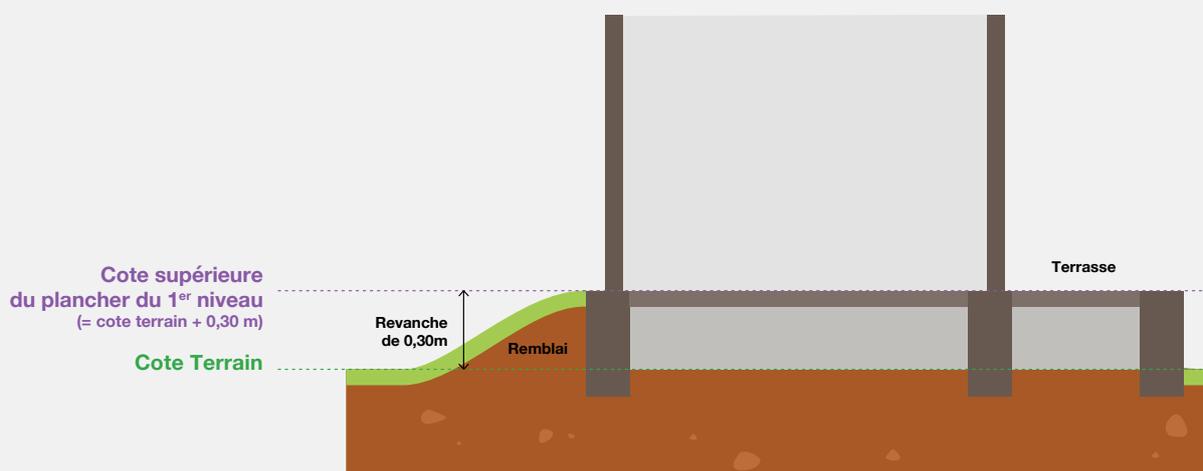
Cote du plancher du 1<sup>er</sup> niveau = cote du terrain + 0,30 m avec remblai.
